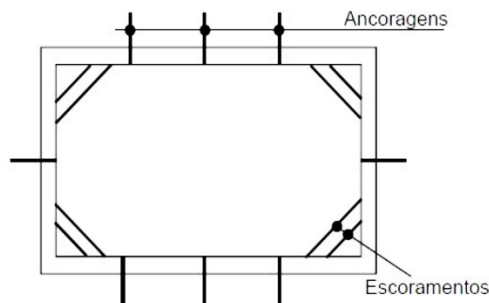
Planta de ancoragens e escoramentos no suporte de uma parede tipo Berlim (Couto, 2014)
